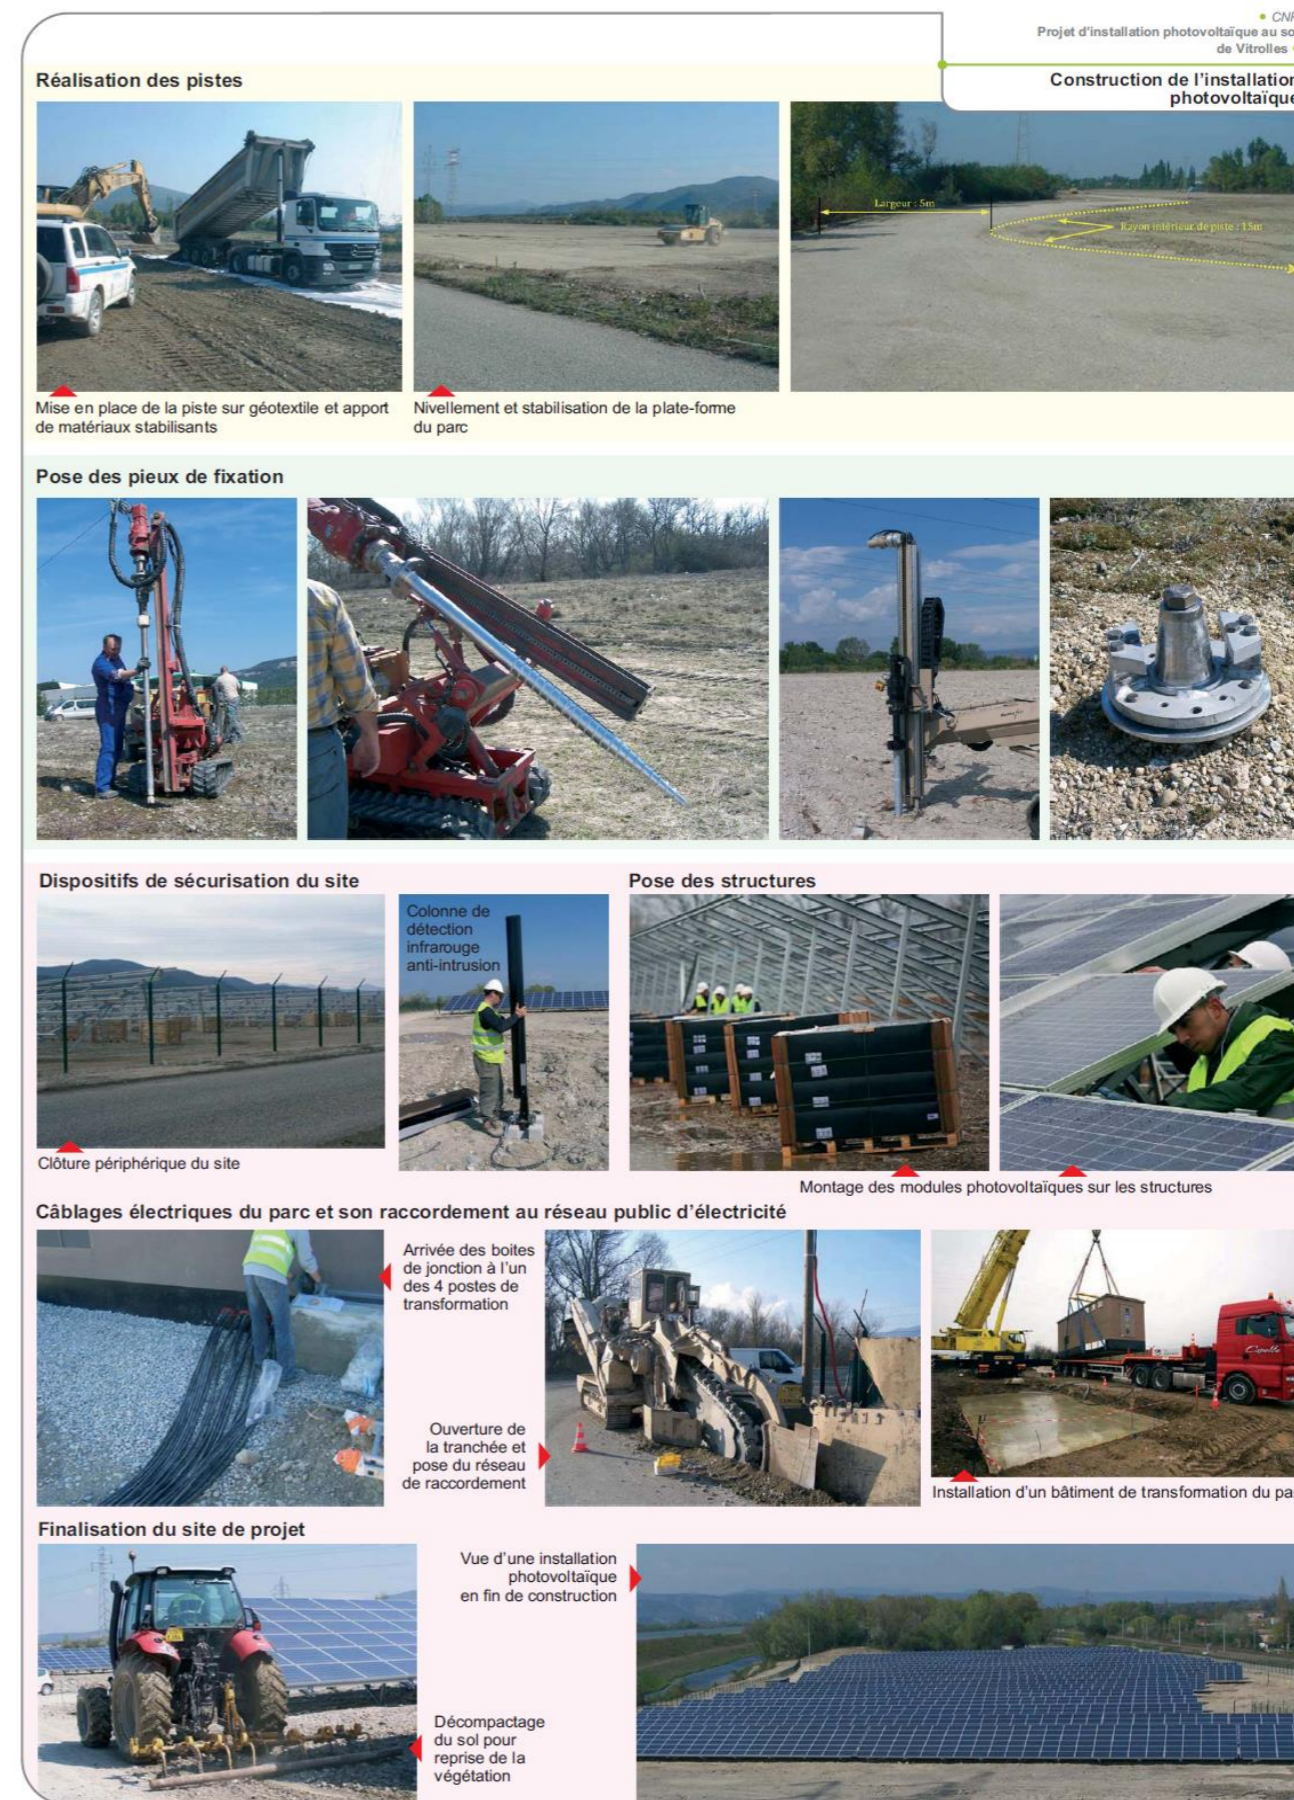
Déroulement type des étapes de construction d'une centrale photovoltaïque
